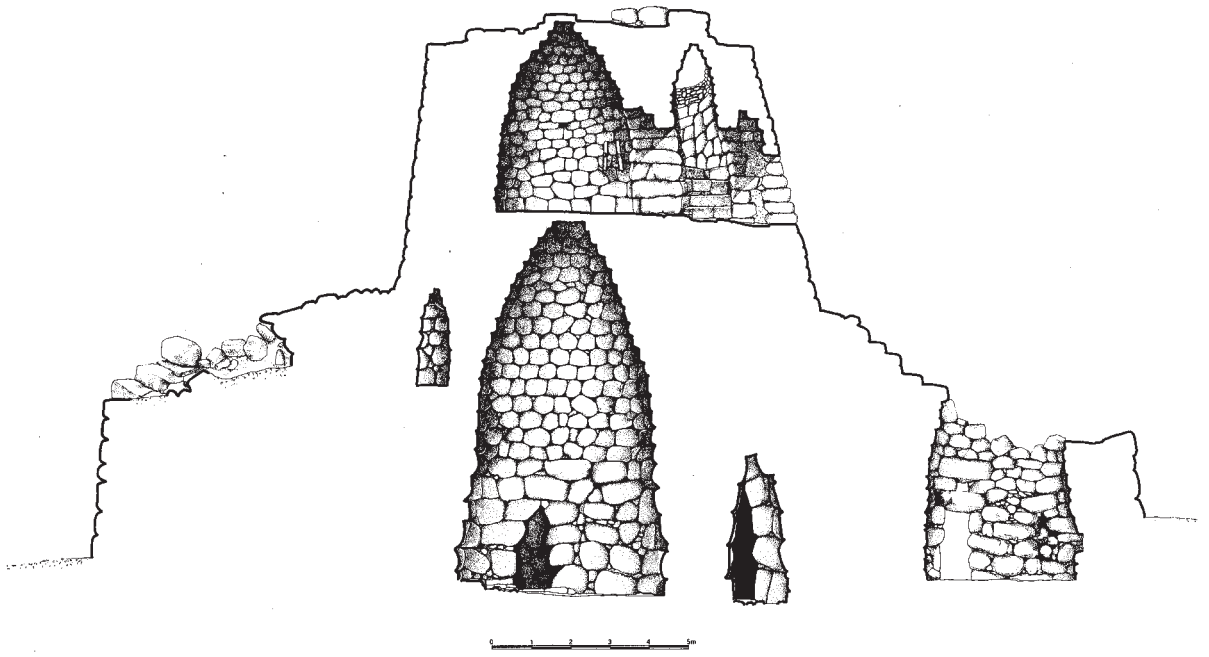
Macomer, Nuraghe Santa Barbara: planimetria.
